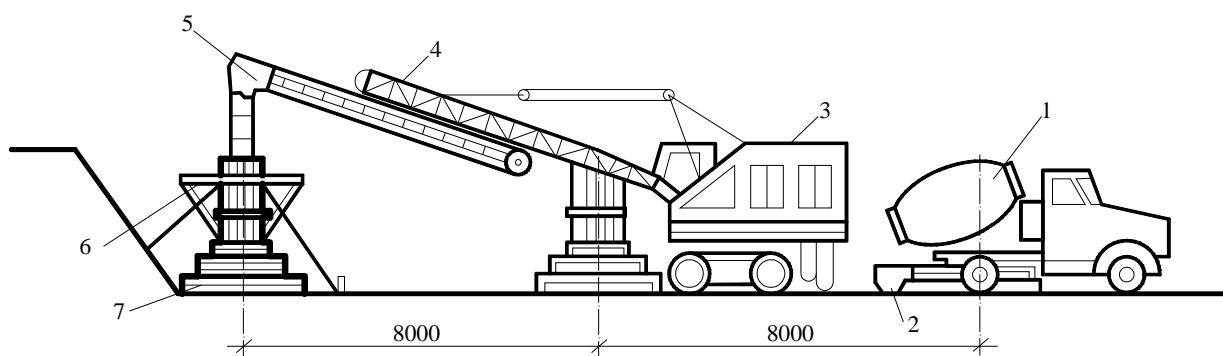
Схема укладання бетонного розчину стрічковим контейнером: 1 – автобетоновіз; 2 – приймальний бункер; 3 – бетоноукладач; 4 – транспортер; 5 – хобіт; 6 – підмостки; 7 – опалубка
